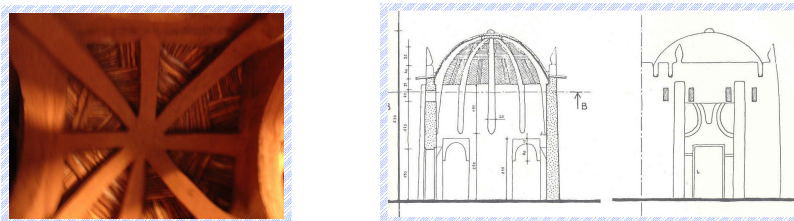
Vue de dessous et une coupe de principe d'une toiture terrasse en terre
